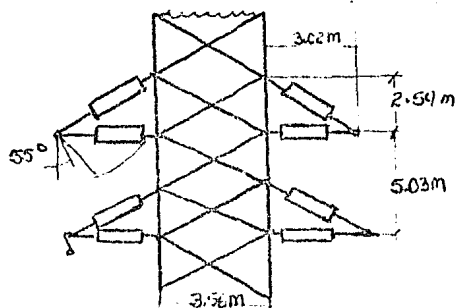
SILUETA DE ESTRUCTURA CON CRUCETA AISLADA.
